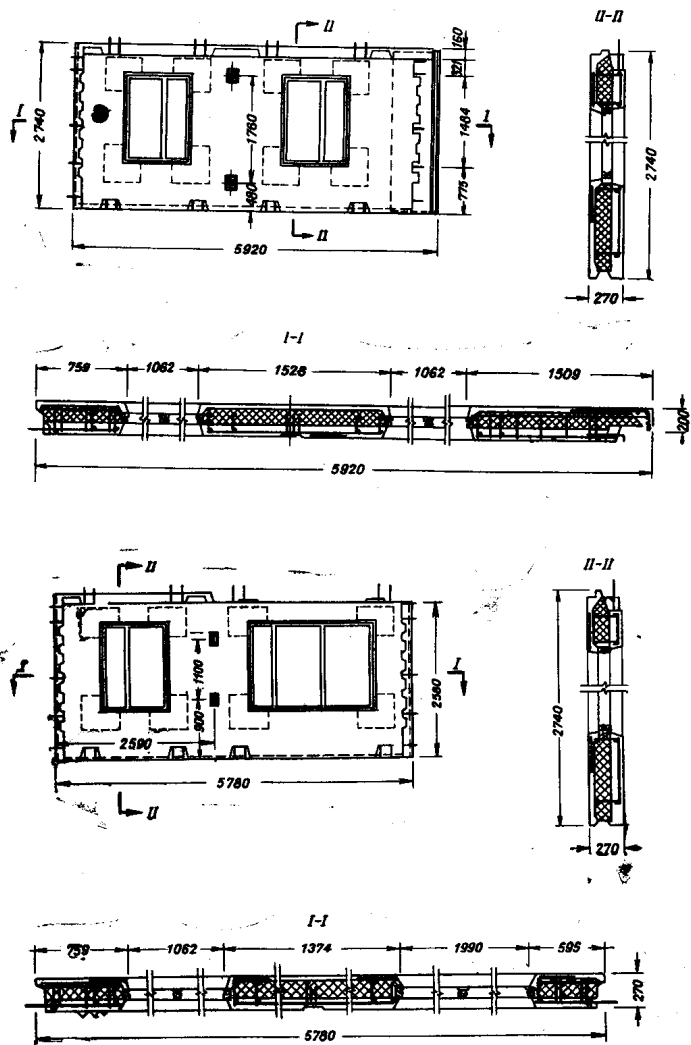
Типы наружных стеновых двухслойных керамзитобетонных панелей
